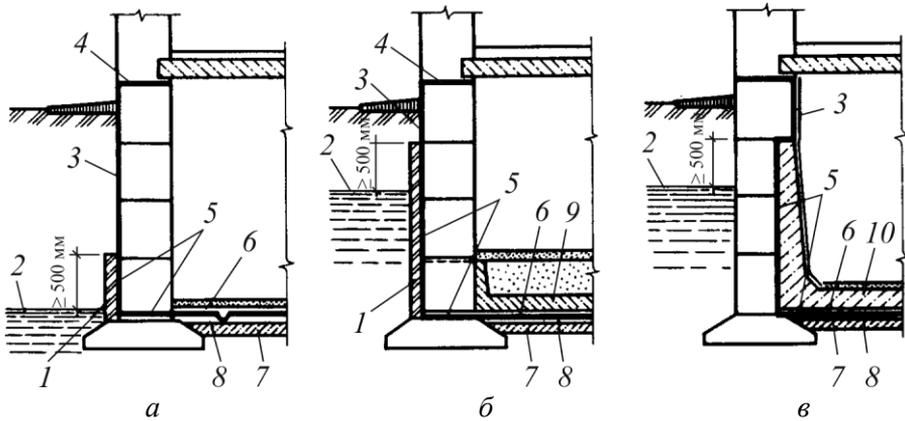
Гидроизоляция подвальных помещений: а – при небольших напорах подземных вод; б, в – при больших напорах подземных вод; 1 – защитная стенка; 2 – уровень подземных вод; 3 – битумная обмазка; 4 – цементный раствор или рулонный материал; 5 – рулонная изоляция; 6 – защитный цементный слой; 7 – бетонная подготовка; 8 – цементная стяжка; 9 – железобетонное ребристое перекрытие; 10 – железобетонная коробчатая конструкция
